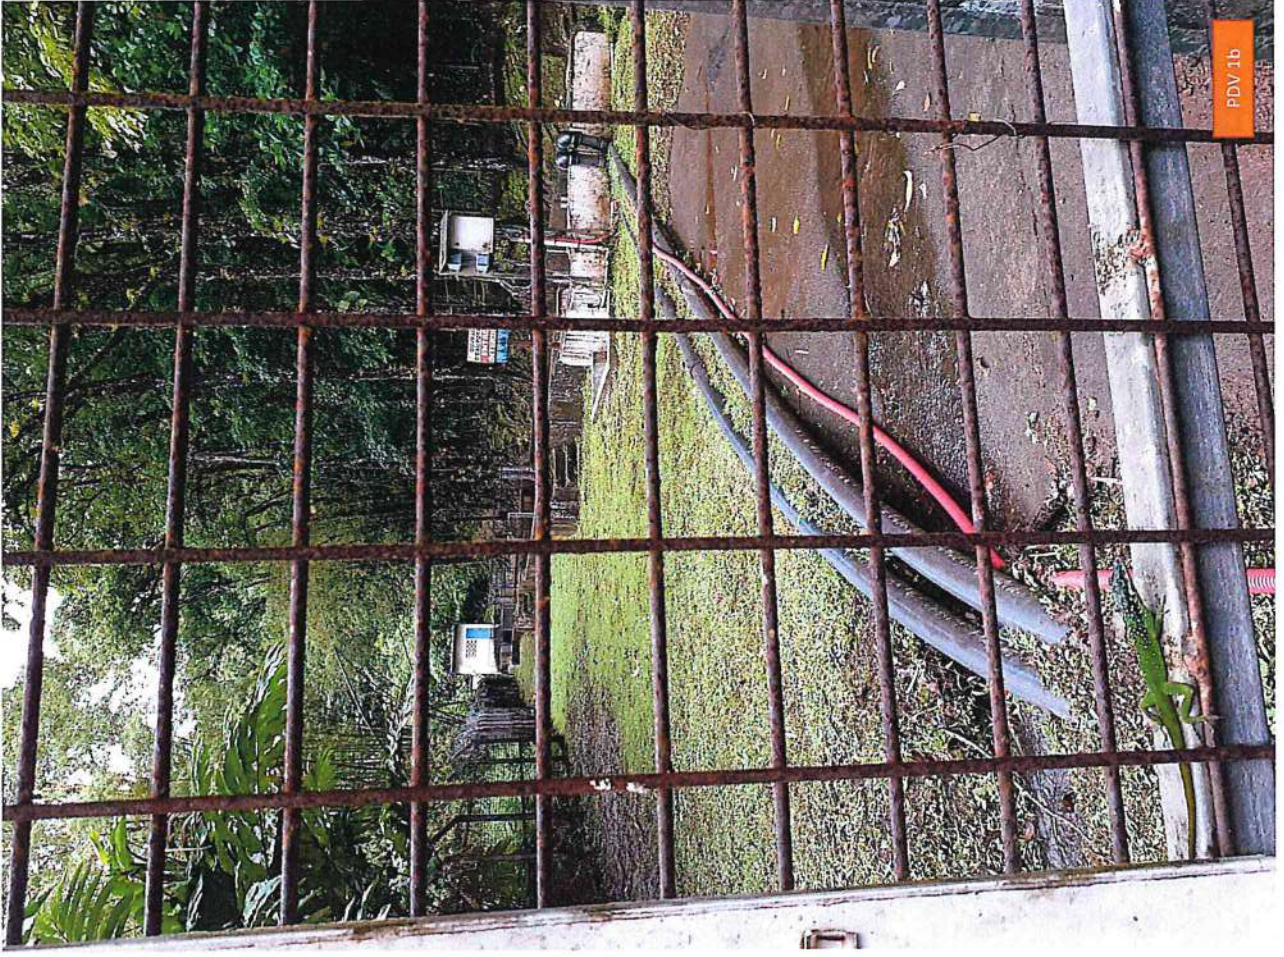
Forage 1 non raccordé et câblage existant jusqu'au dessableur
